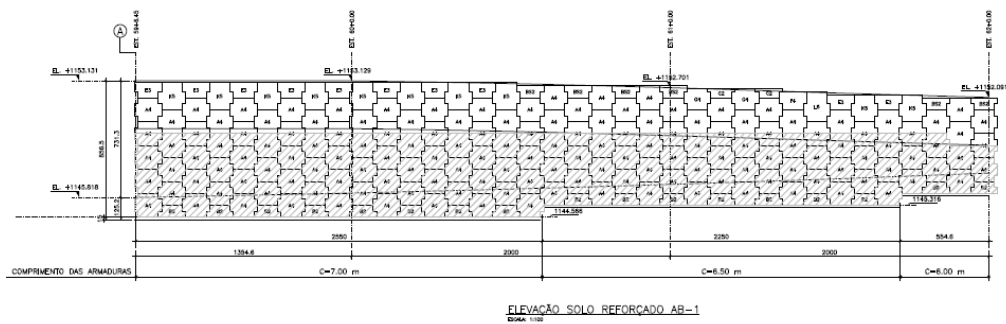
Elevação Solo Reforçado Eixos AB-1
